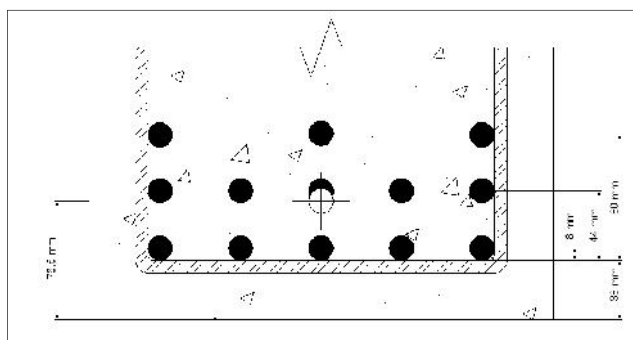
Arranjo de armaduras para o tirante 8.
